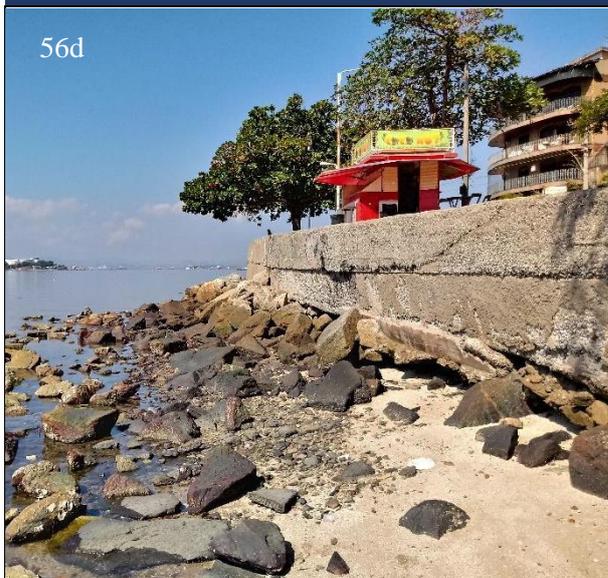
desgaste do muro de arrimo, aparentemente causado pela erosão.
